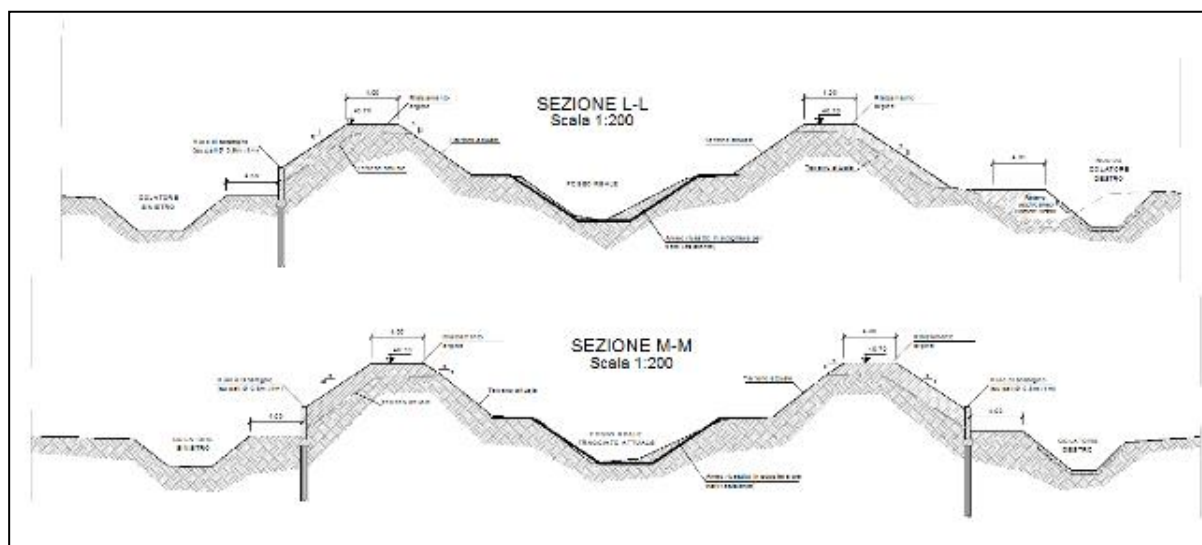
Sezione di progetto Canale Scolmatore tratto esistente da adeguare
